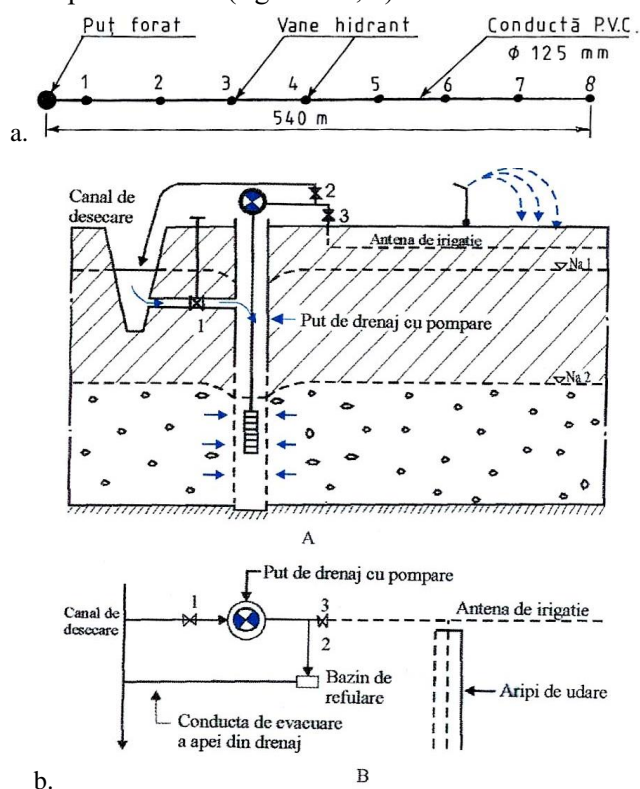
a. Puț cu o pompă și conductă PVC b. Secțiunea transversală „A” și vedere în plan „B” pentru evidențierea funcționării amenajării de reglare bilaterală a umidității solurilor în incinta Dăbuleni – Potelu – Corabia
